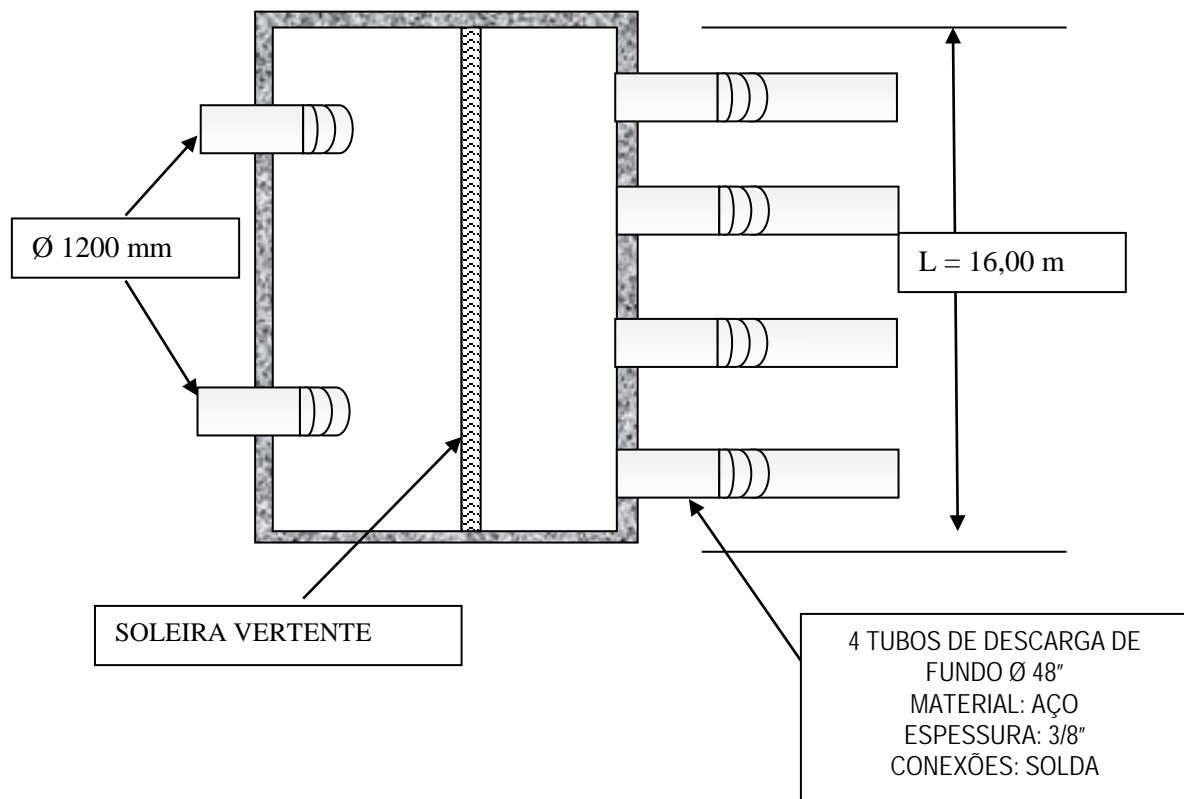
Estrutura de Dissipação e Descarga Jaguari - Planta
